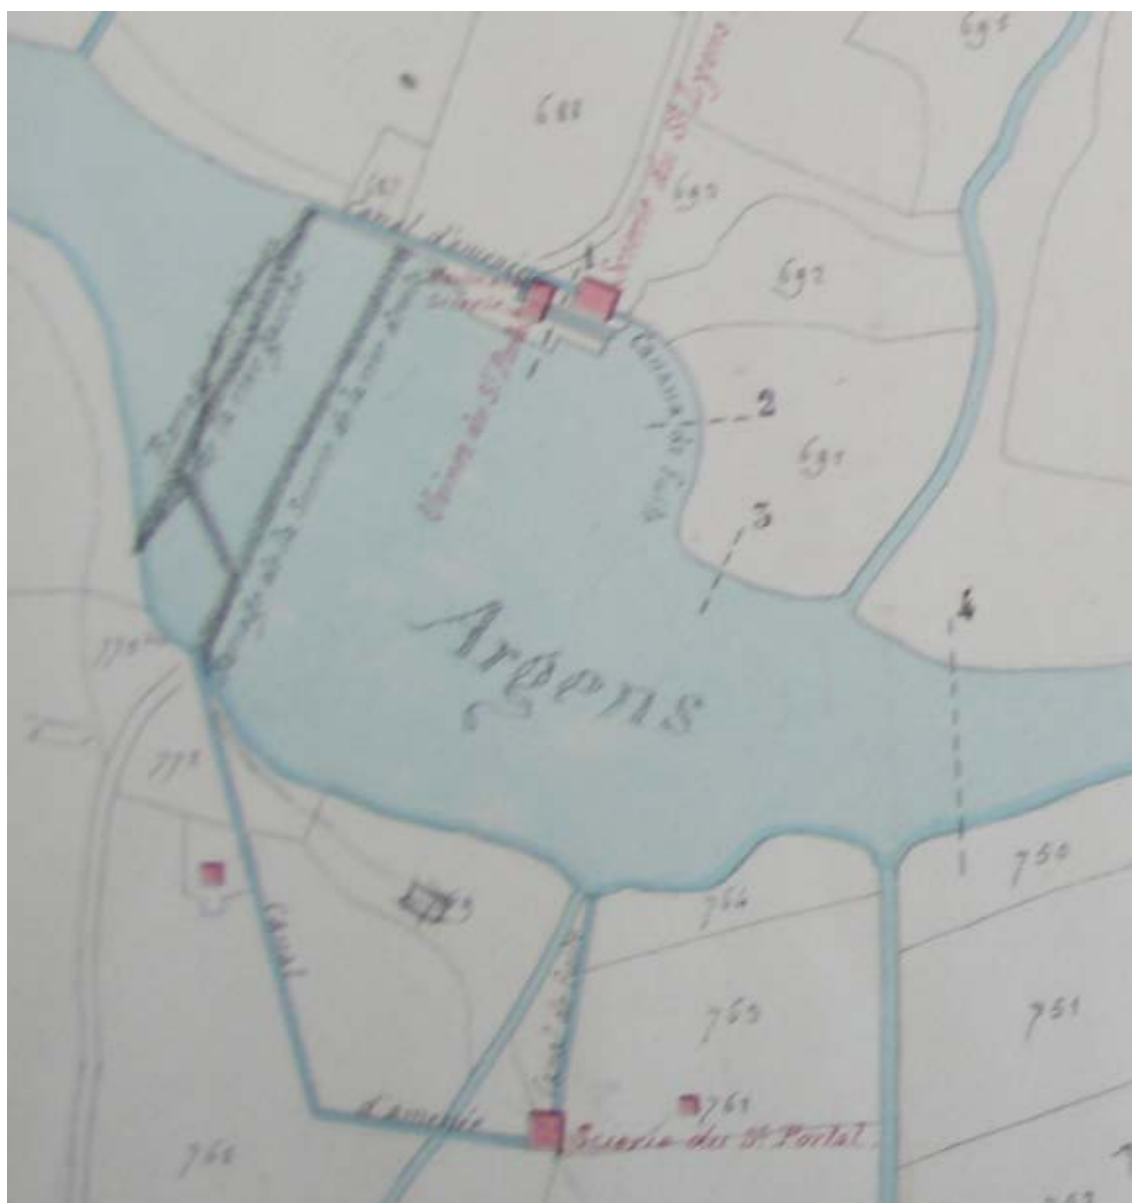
Plan de la demande faite par M. Portal pour la construction d'une nouvelle scierie en rive droite l'Argens (1863)
